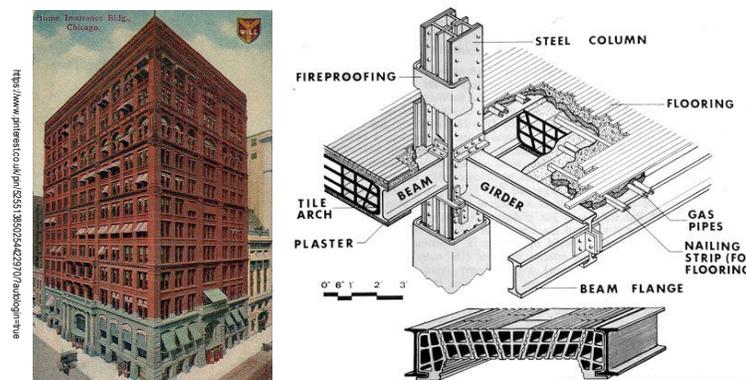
EL HOME INSURANCE COMPANY BUILDING Y DETALLE DE LA UNIÓN DE COLUMNAS Y VIGAS. (COLUMBIA, S/F)
